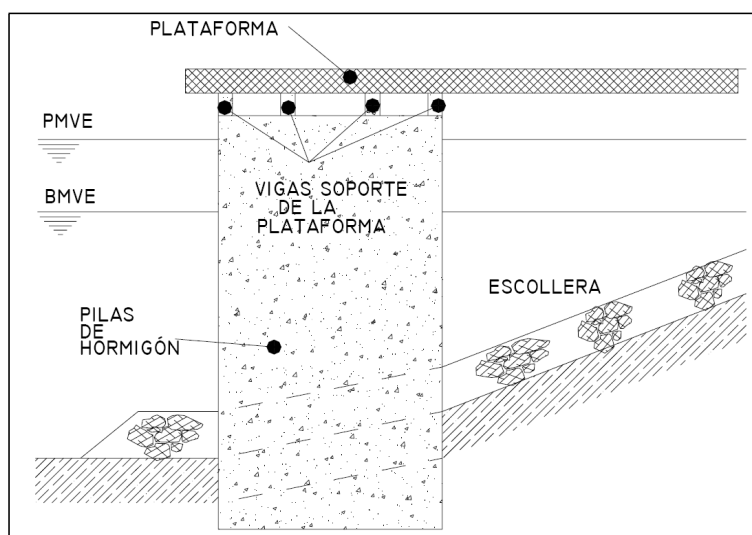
Sección tipo de un muelle plataforma sobre pilas
